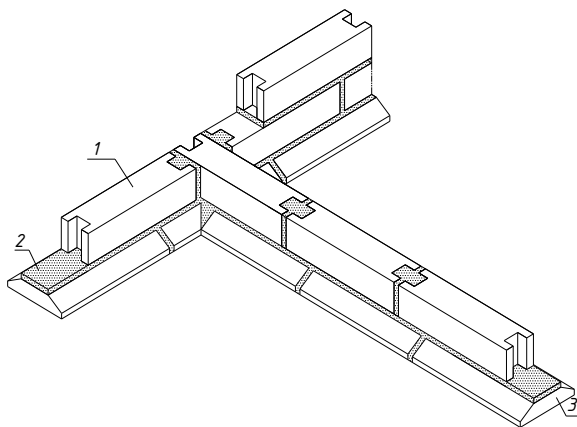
Вариант сборного ленточного фундамента: 1-фундаментный блок, ФБС; 2-цементно-песчаный раствор; 3-фундаментная плита, ФЛ
